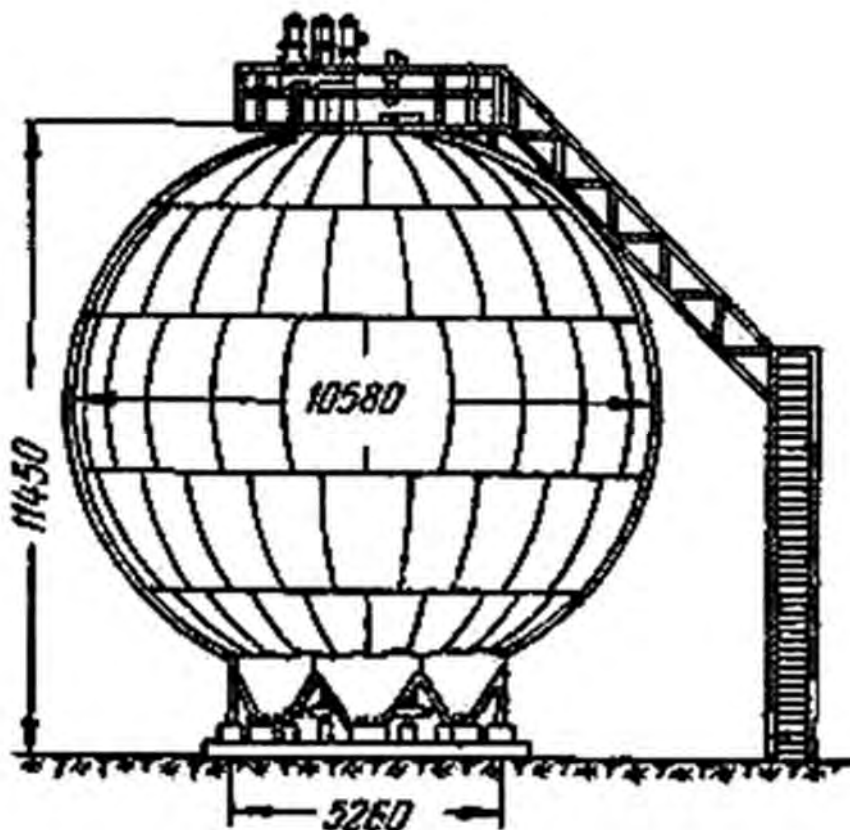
Шаровой резервуар емкостью  $600 \text{ м}^3$ , опирающийся на цилиндрический стакан
